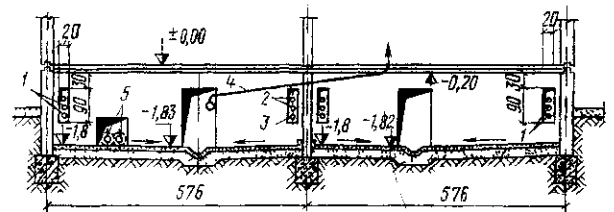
Схема размещения коммуникаций в техническом подполье здания при строительстве на просадочных грунтах
